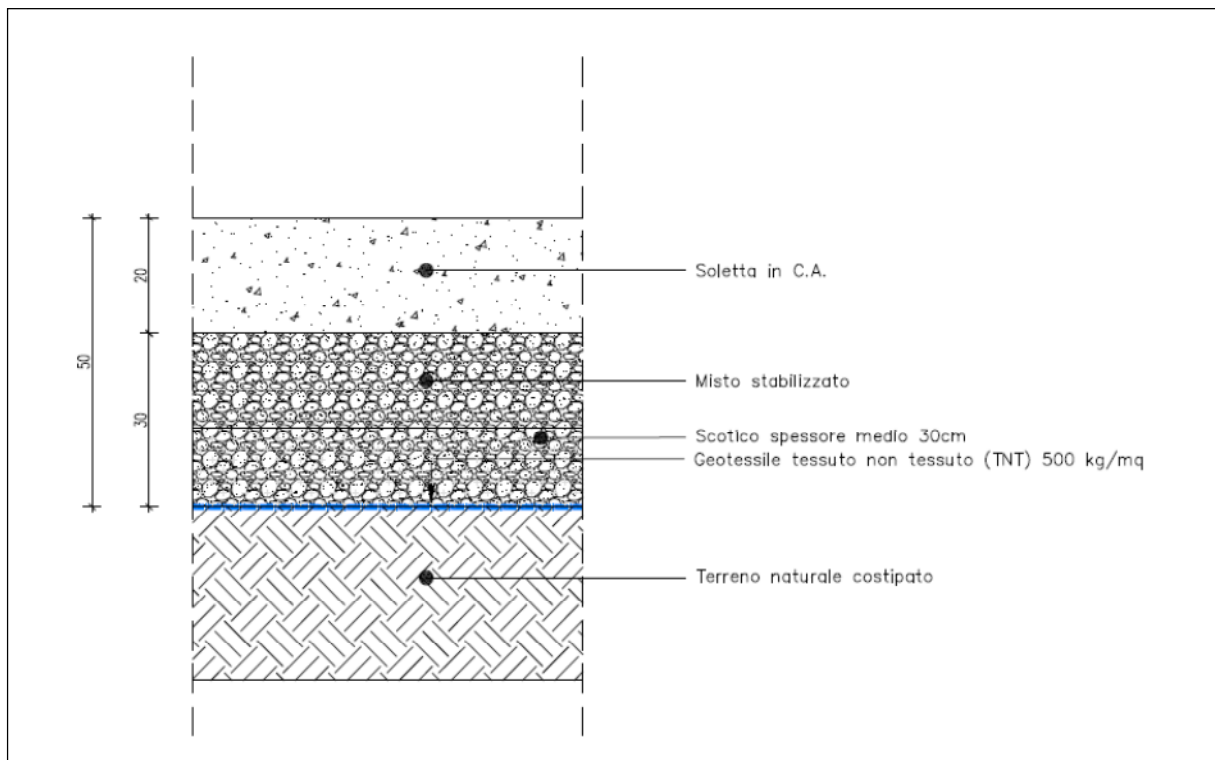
Pavimentazione tipo piazzola elisoccorso
